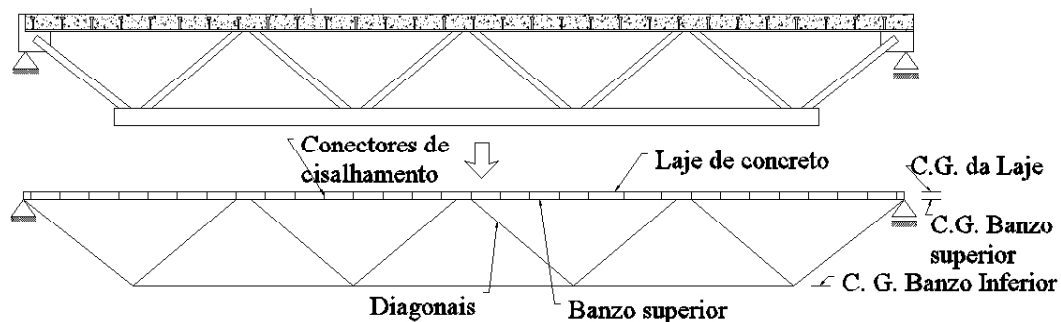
Exemplo de um modelo em pórtico plano proposto por Chien & Ritchie (1984)
